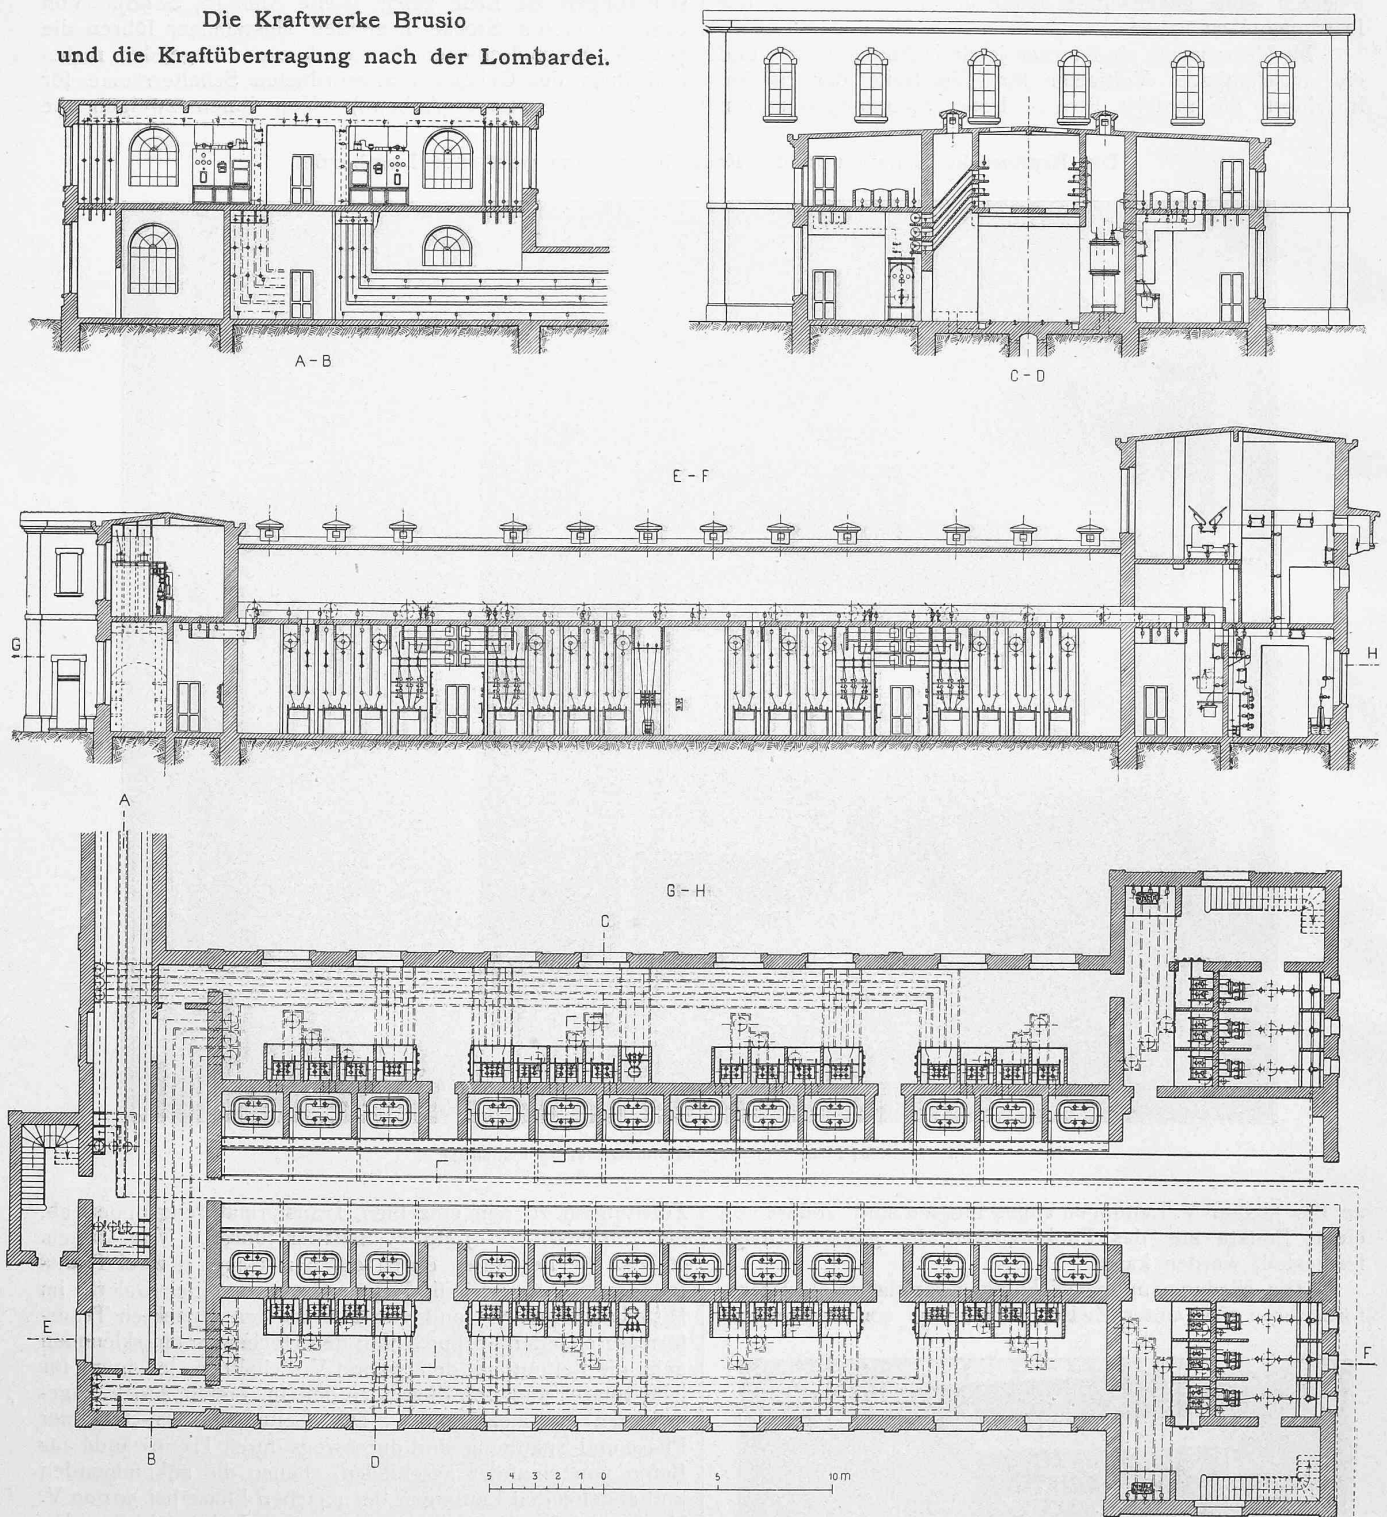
Transformatorstation Piattamala. — Grundriss und Schnitte. — Masstab 1 : 300.
